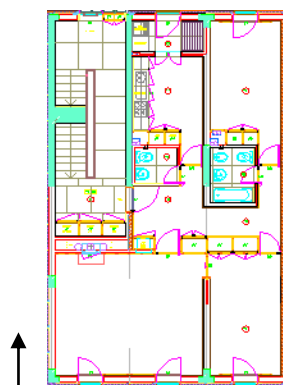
Planta do apartamento com orientação base dos envidraçados (Norte – Sul)
